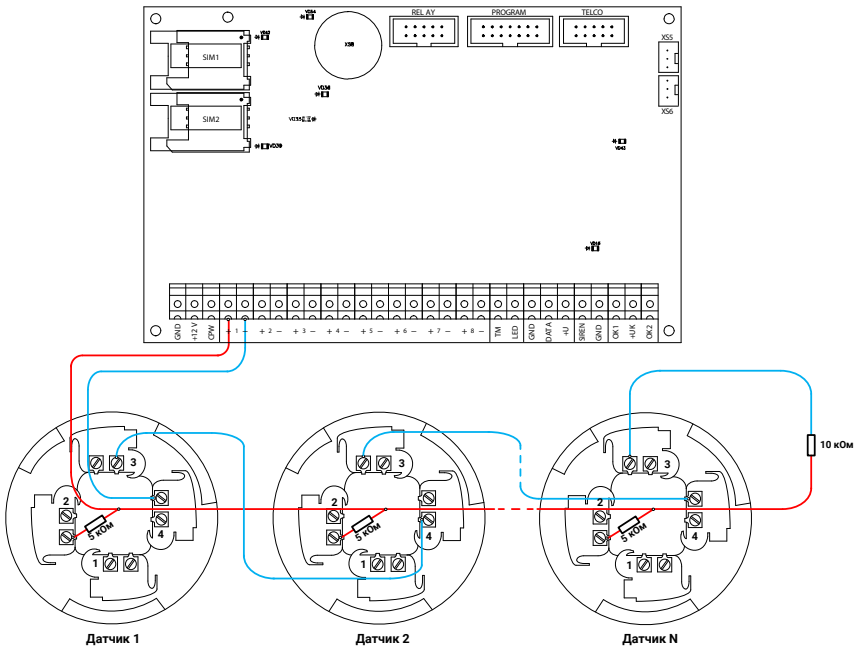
Схема подключения пожарных шлейфов с контролем обрыва
